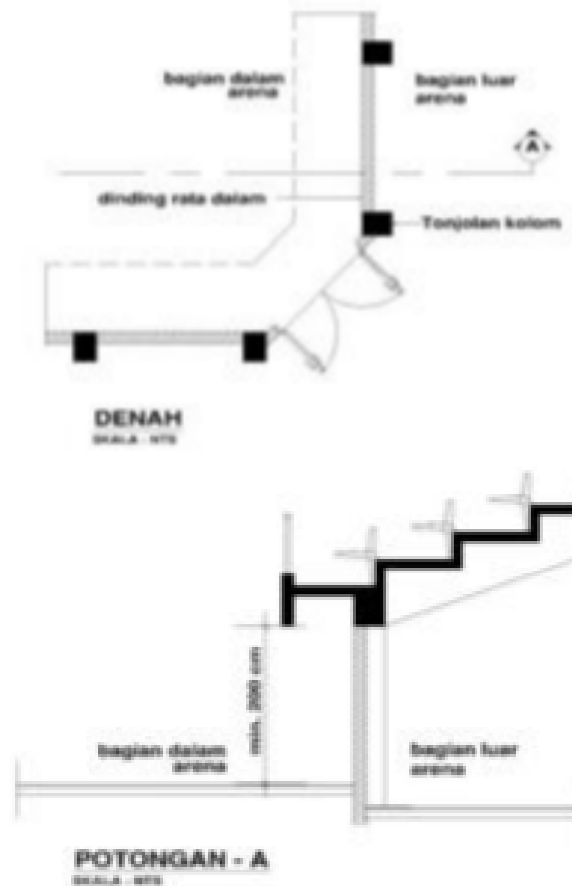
9 Standar ketentuan lantai arena gedung olahraga
